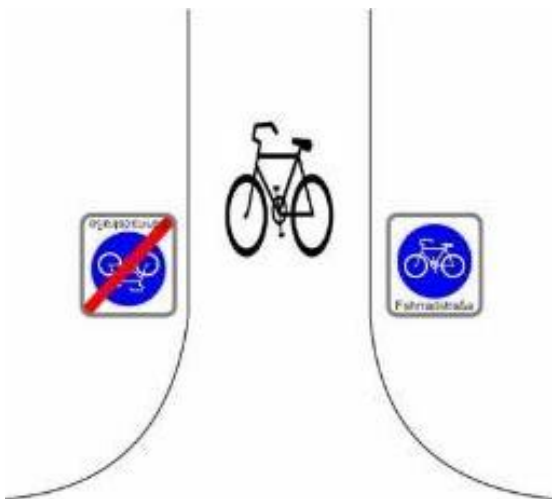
Markierung und Beschilderung Fahrradstraße (lt. RVS 03.02.13)
